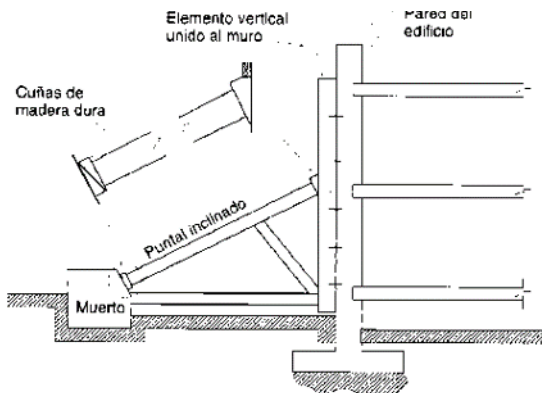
Apuntalamiento lateral de pared. (Meli, R. 1998)
